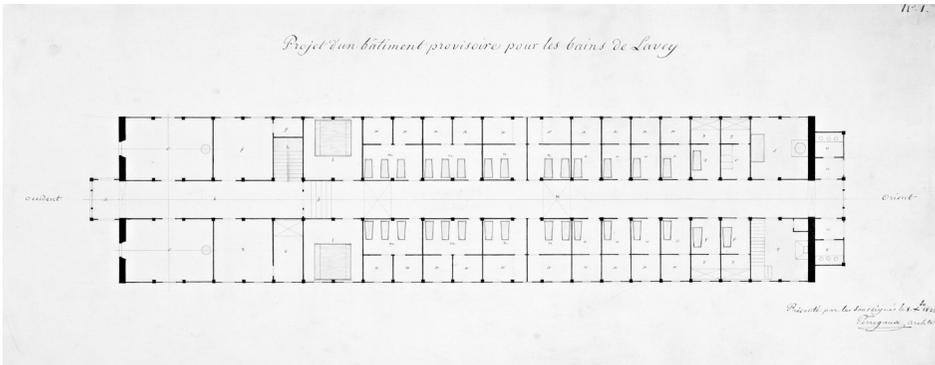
Lavey, bains, projet d'Henri Perregaux, plan, 1835 (ACV).
